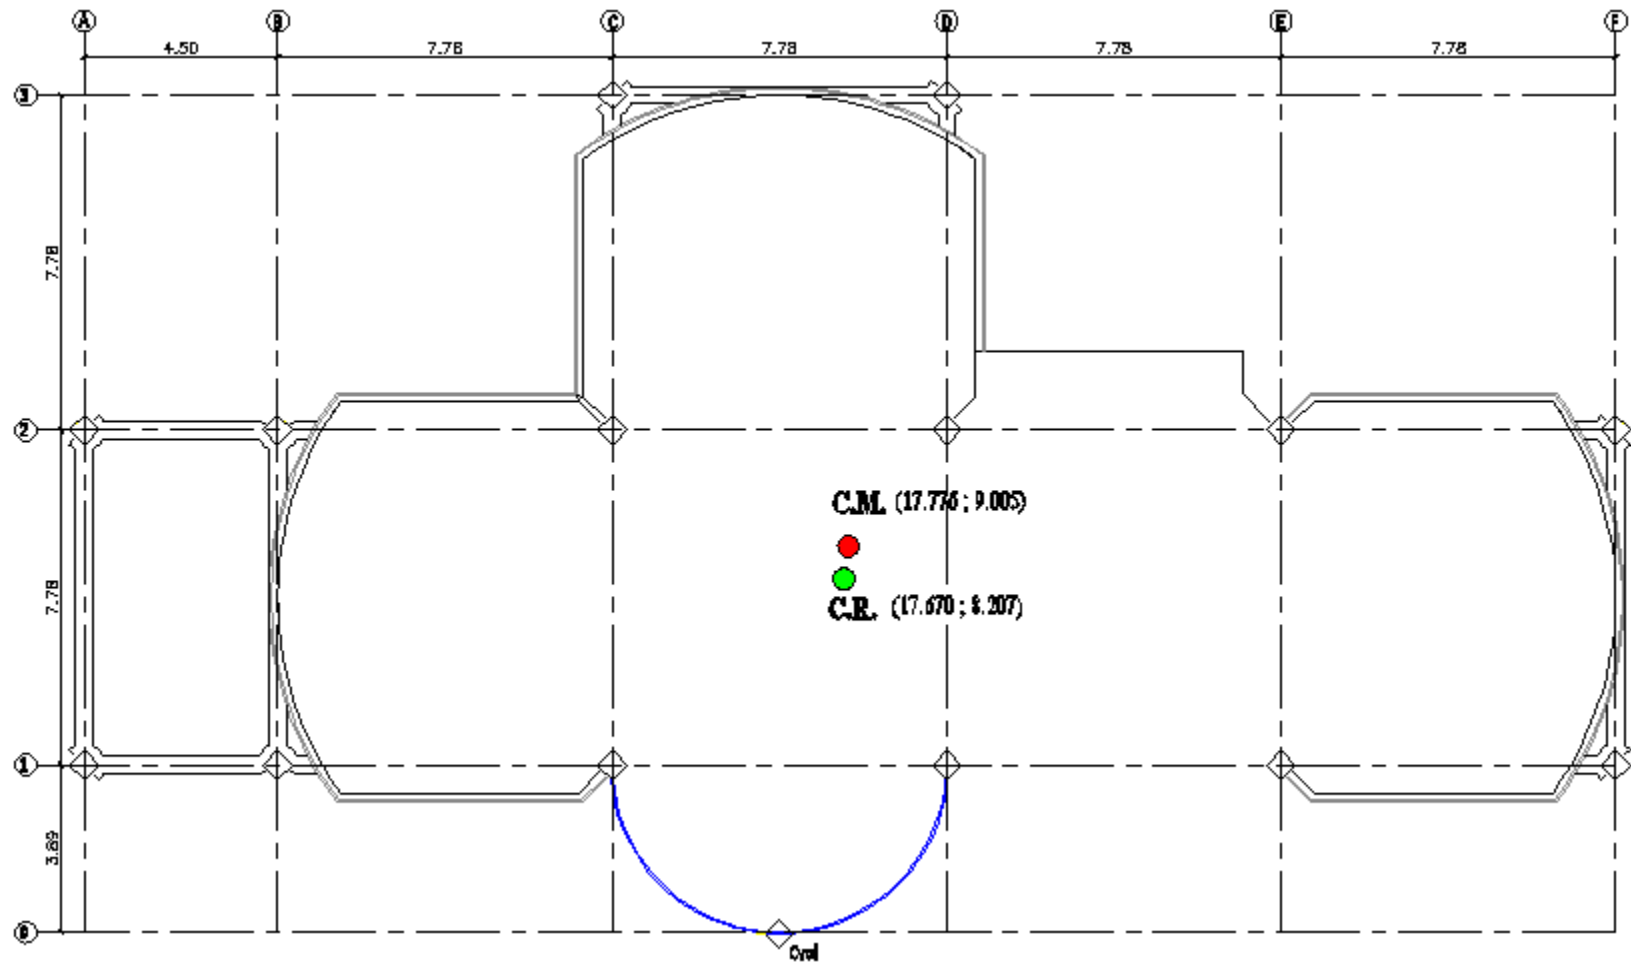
Centro de Masas y Rigidez de la Losa N+3.08
